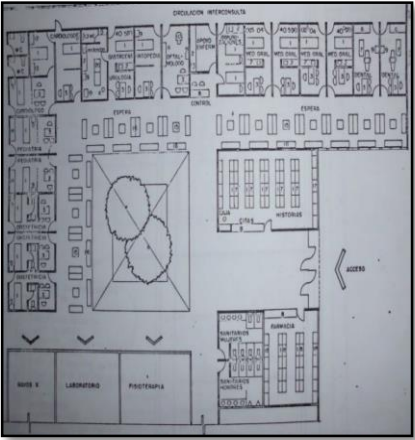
(Función según planta arquitectónica de consulta externa) (Retomada por autores de la guía de hospitales para América latina)
